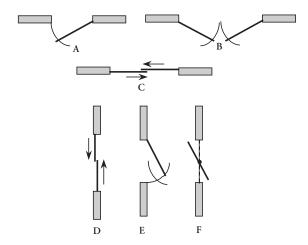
Formas de abrir de una ventana (A -B -C vista en planta, D -E -F vista en corte) (Hunting, 1981).
